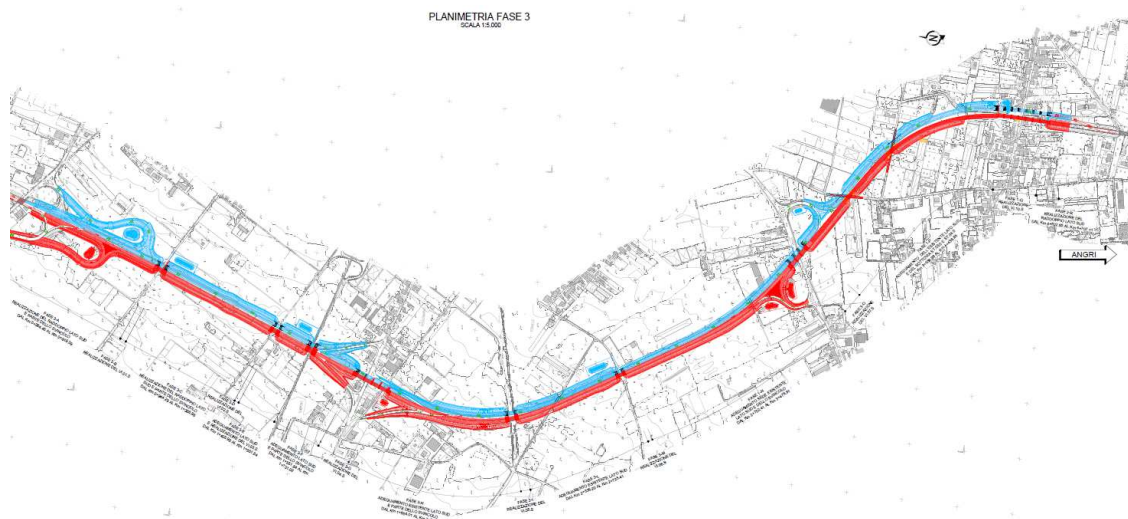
Stralcio planimetrico Macro-Fase 3.
